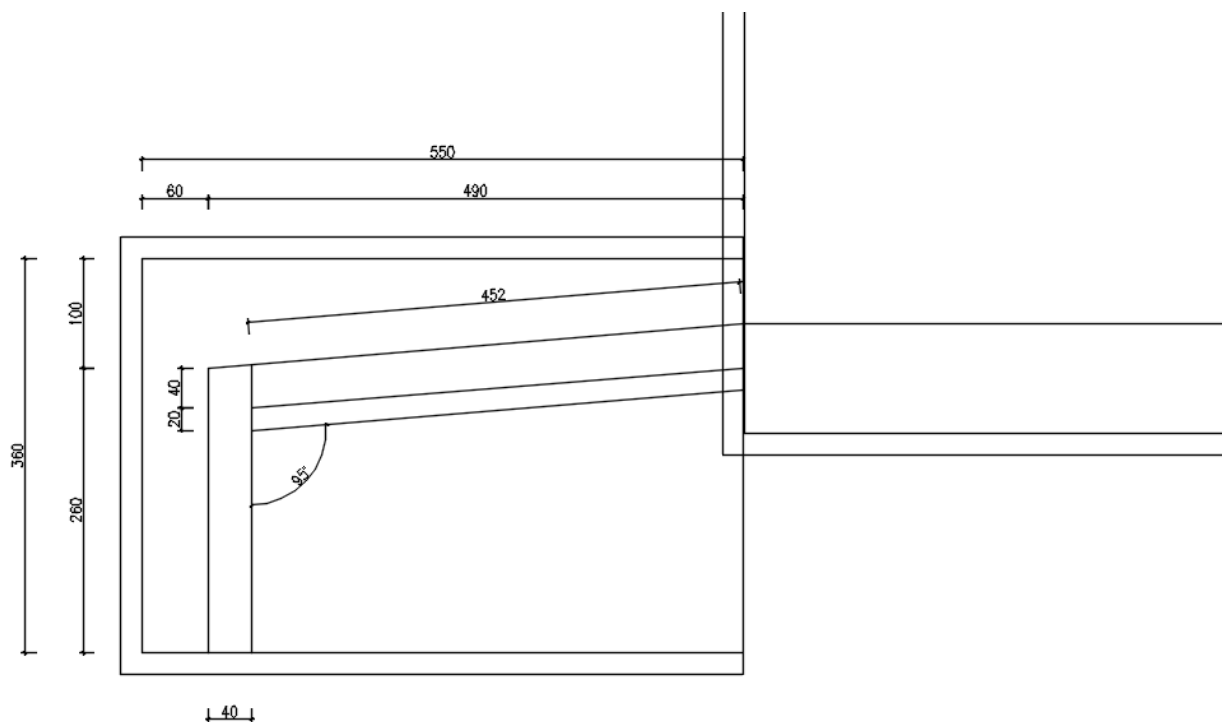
Pianta del muro di estremità del sottopasso SL02
